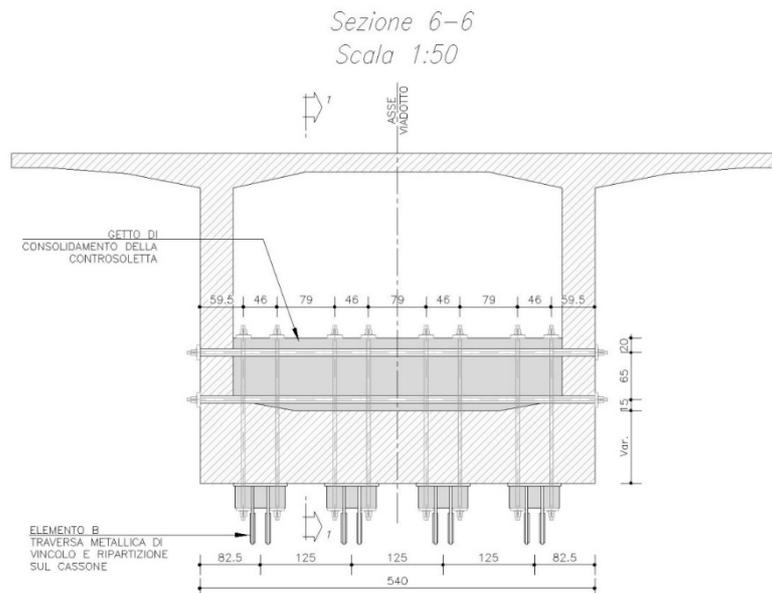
Spalla Sp.3 - Sezione trasversale in asse connessione dispositivi su viadotto
